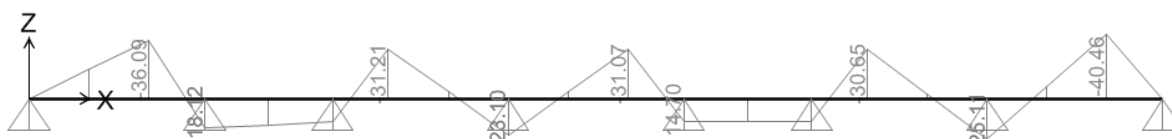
Trave di fondazione : momenti flettenti SLU
